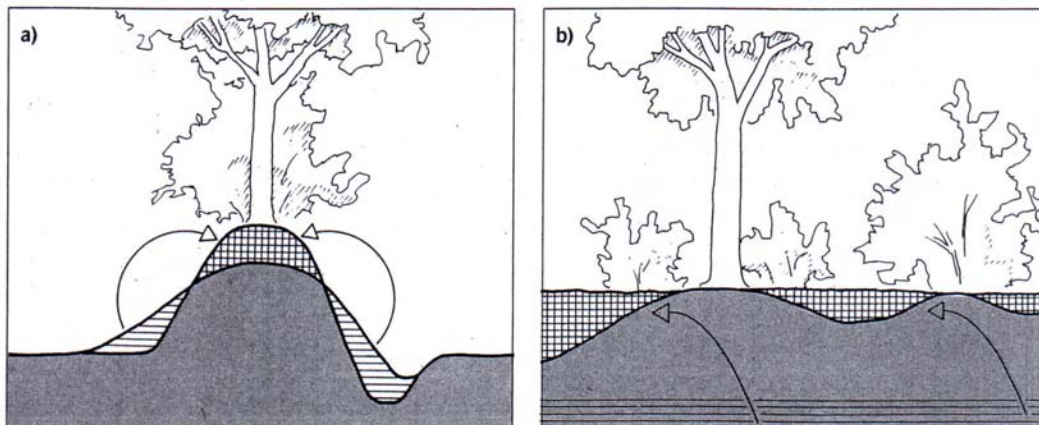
Instandsetzen eines Wallkörpers a) Querschnitt, b) Seitenansicht
